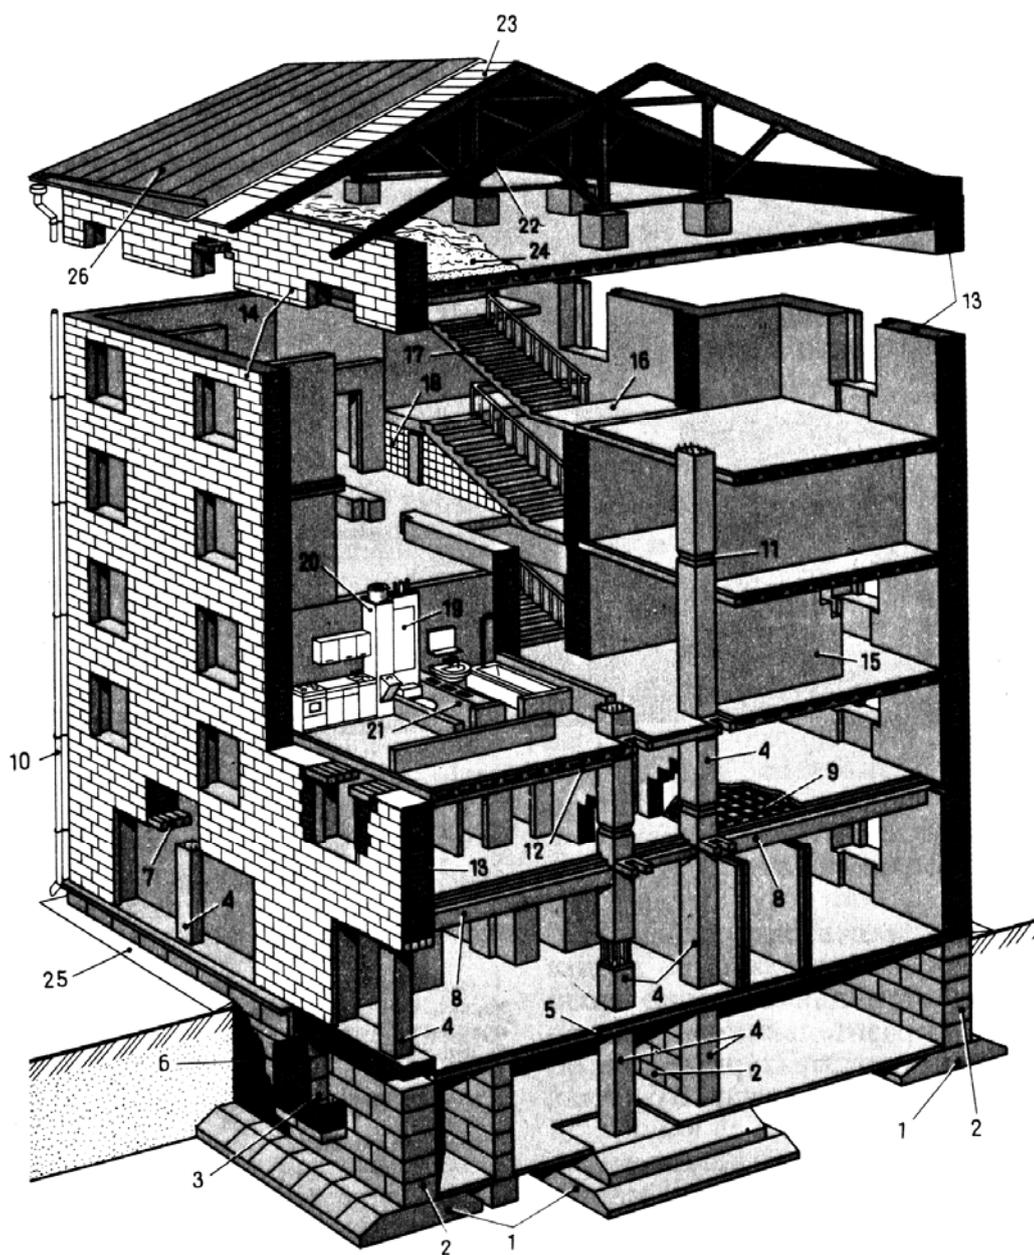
Конструктивная схема жилого дома с неполным каркасом:
